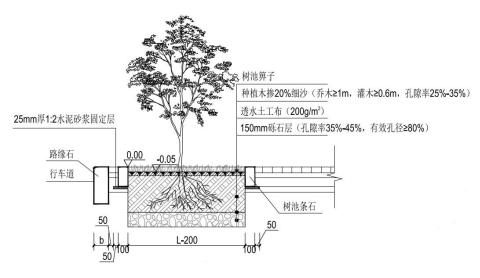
水泥树池剖面图 (单位: mm)
